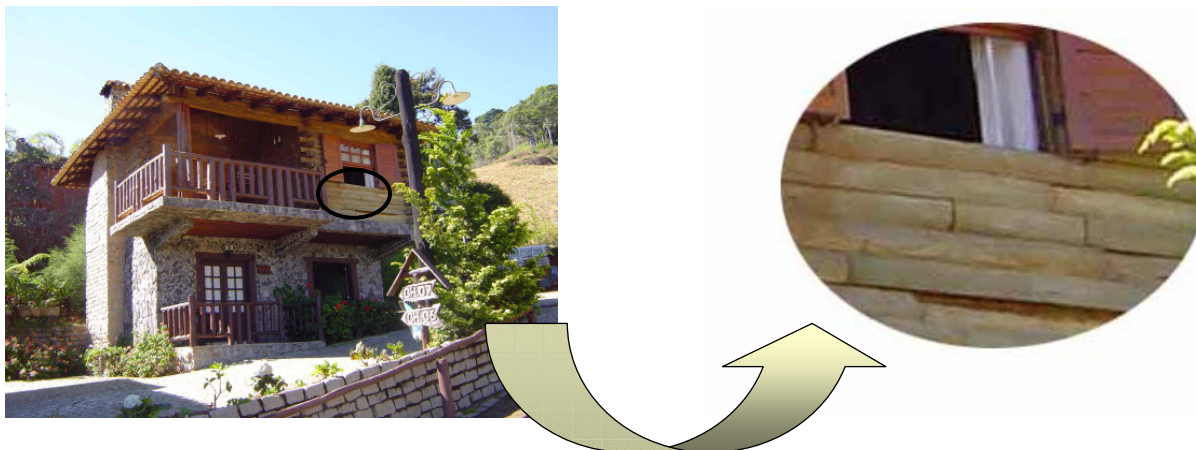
7: Vista e detalhe da fachada oeste do chalé Peterly's
